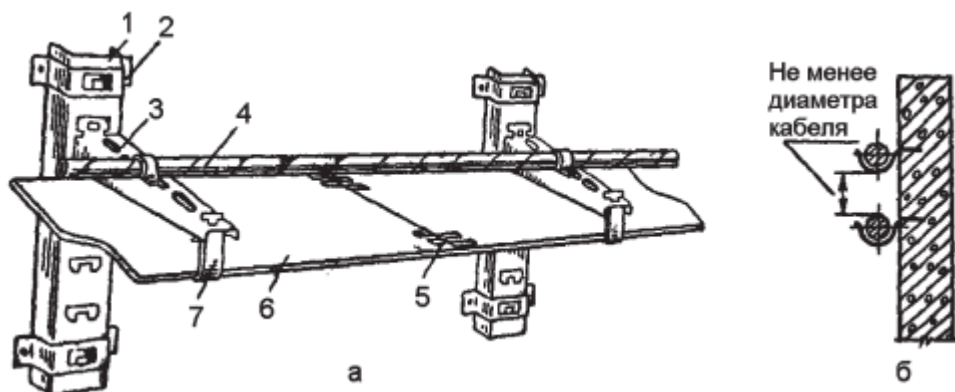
Открытая прокладка кабелей: а – на сборных кабельных конструкциях; б – на скобах по стенам: 1 – стойка; 2 – скоба; 3 – полка; 4 – кабель; 5 – соединение перегородок; 6 – асбестоцементная плита; 7 – подвеска
